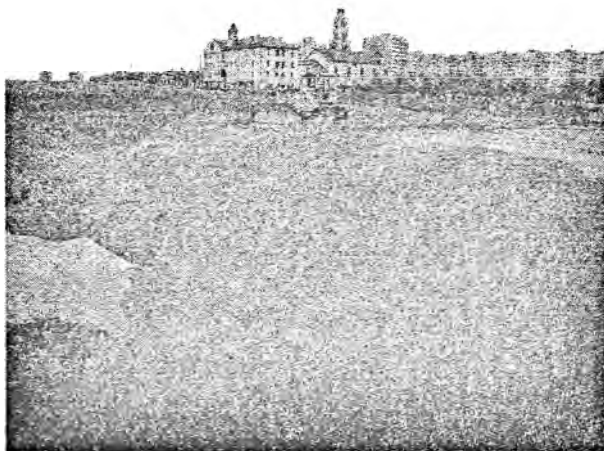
Отсыпка и послыное уплотнение насыпного песчаного основания
